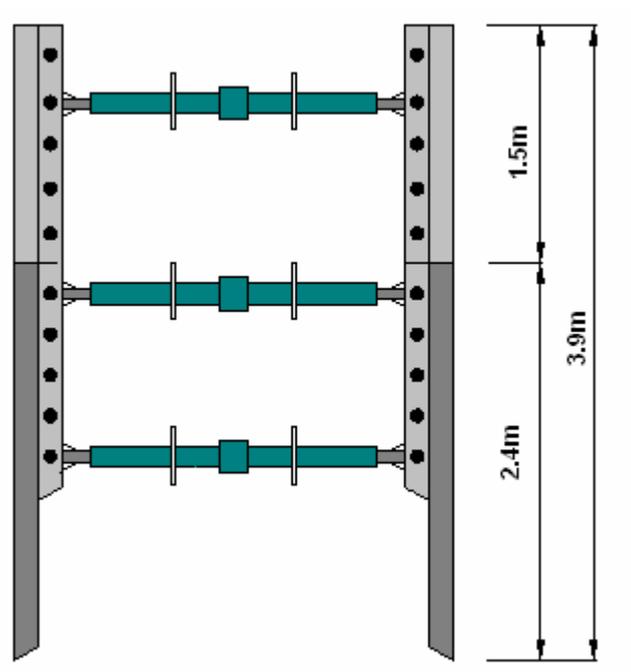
Vista Frontal Entibaciones Metálicas, Sistema Cajón./Elaboración Propia.
